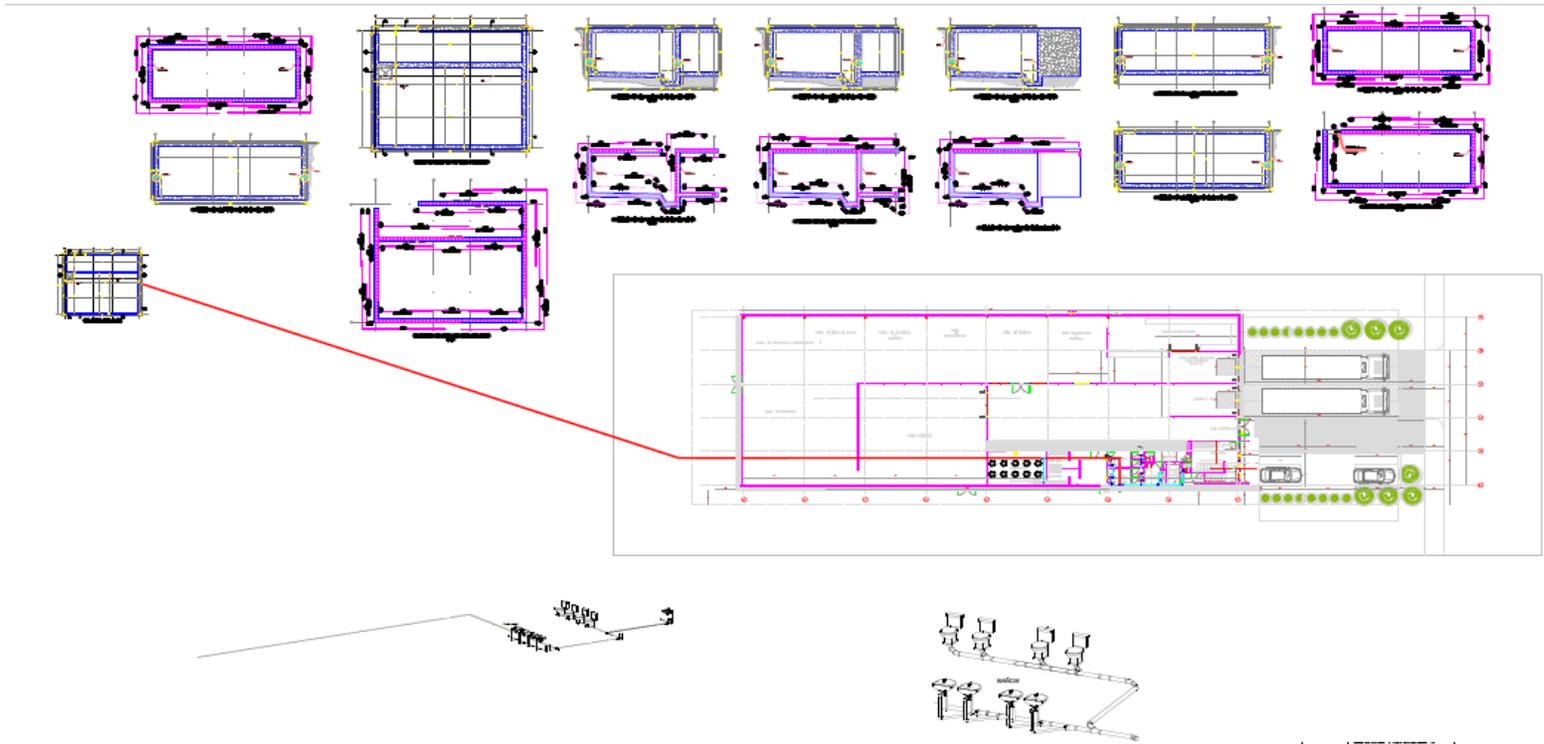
Planta de Alzada, Estructura y Tanque de Almacenamiento
